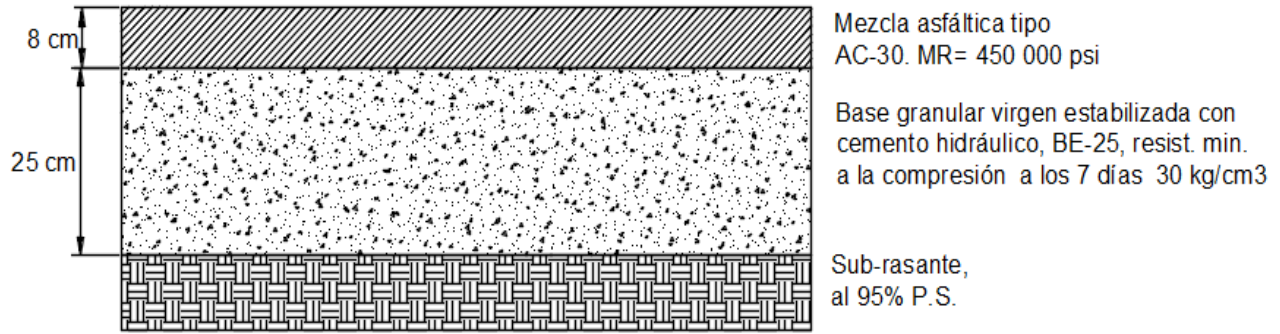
Perfil de la estructura de pavimento propuesta para el TH=1, P#1-P#3.
